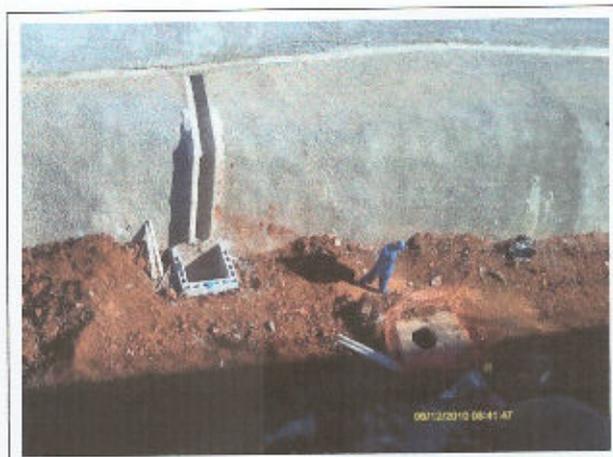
Instalação da drenagem superficial para escoamento das águas pluviais do talude
